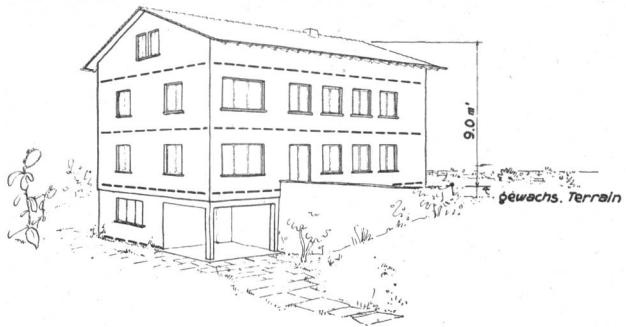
Haus mit zwei Vollgeschossen und mit Dach- und Untergeschoss, § 3.
